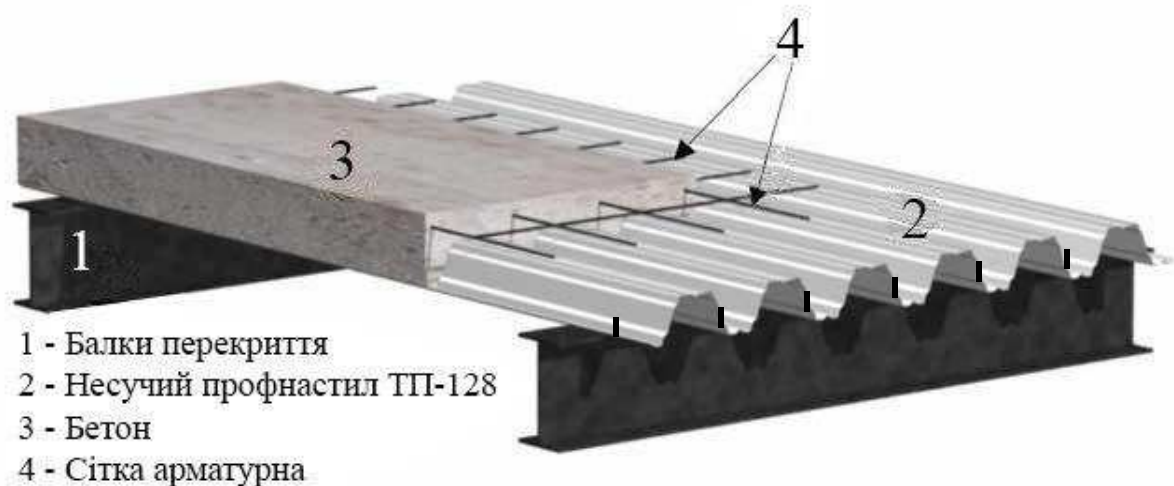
Улаштування перекриття по профільованому металевому настилу з залізобетонною плитою
